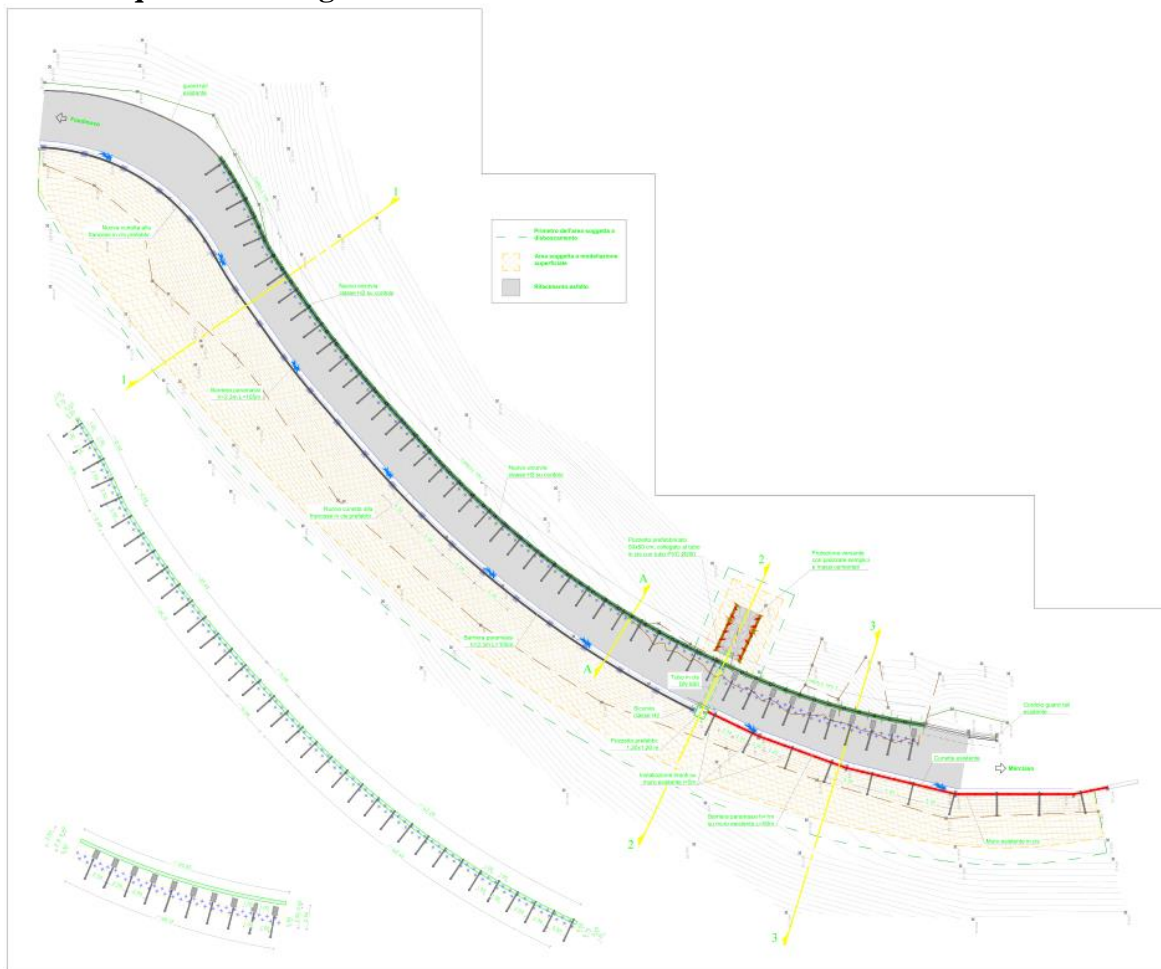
Indicazione planimetrica interventi – configurazione finale
